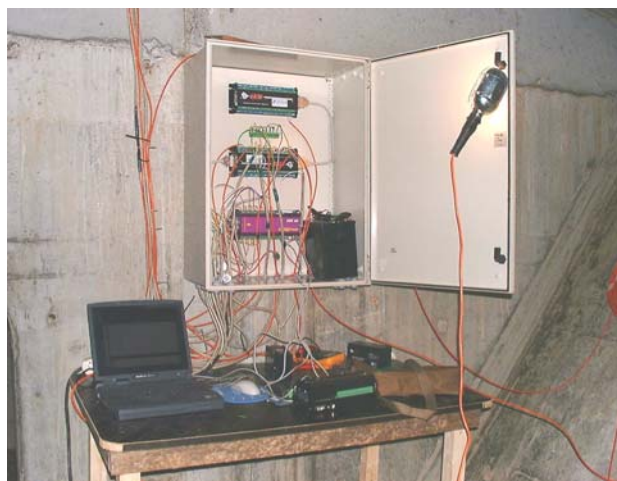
Exemplo de um posto de observação instalado em obra.
